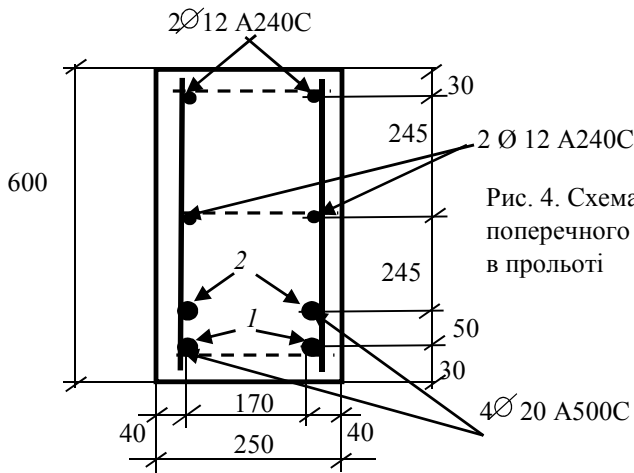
Схема армування поперечного перерізу балки в прольоті
